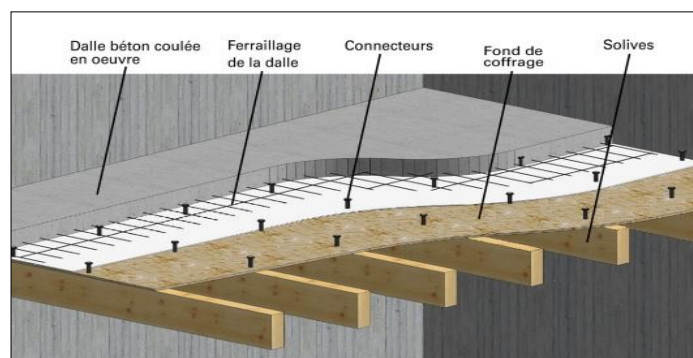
Photo montrant les composants du plancher mixte Source : https://www.programmepacte.fr/sites/default/files/pdf/recommandation-pro-rage-moe-isolation-planchers-mixtes-bois-beton-reno-2015-03_0.pdf
